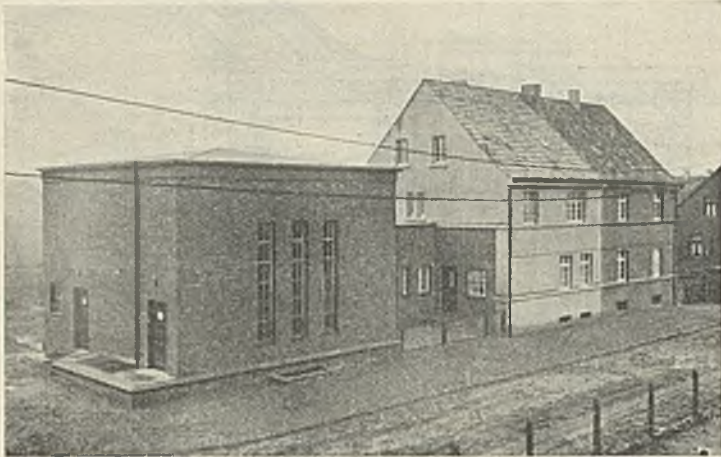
Ansicht des Pumpwerks Sterkrade von Norden.
